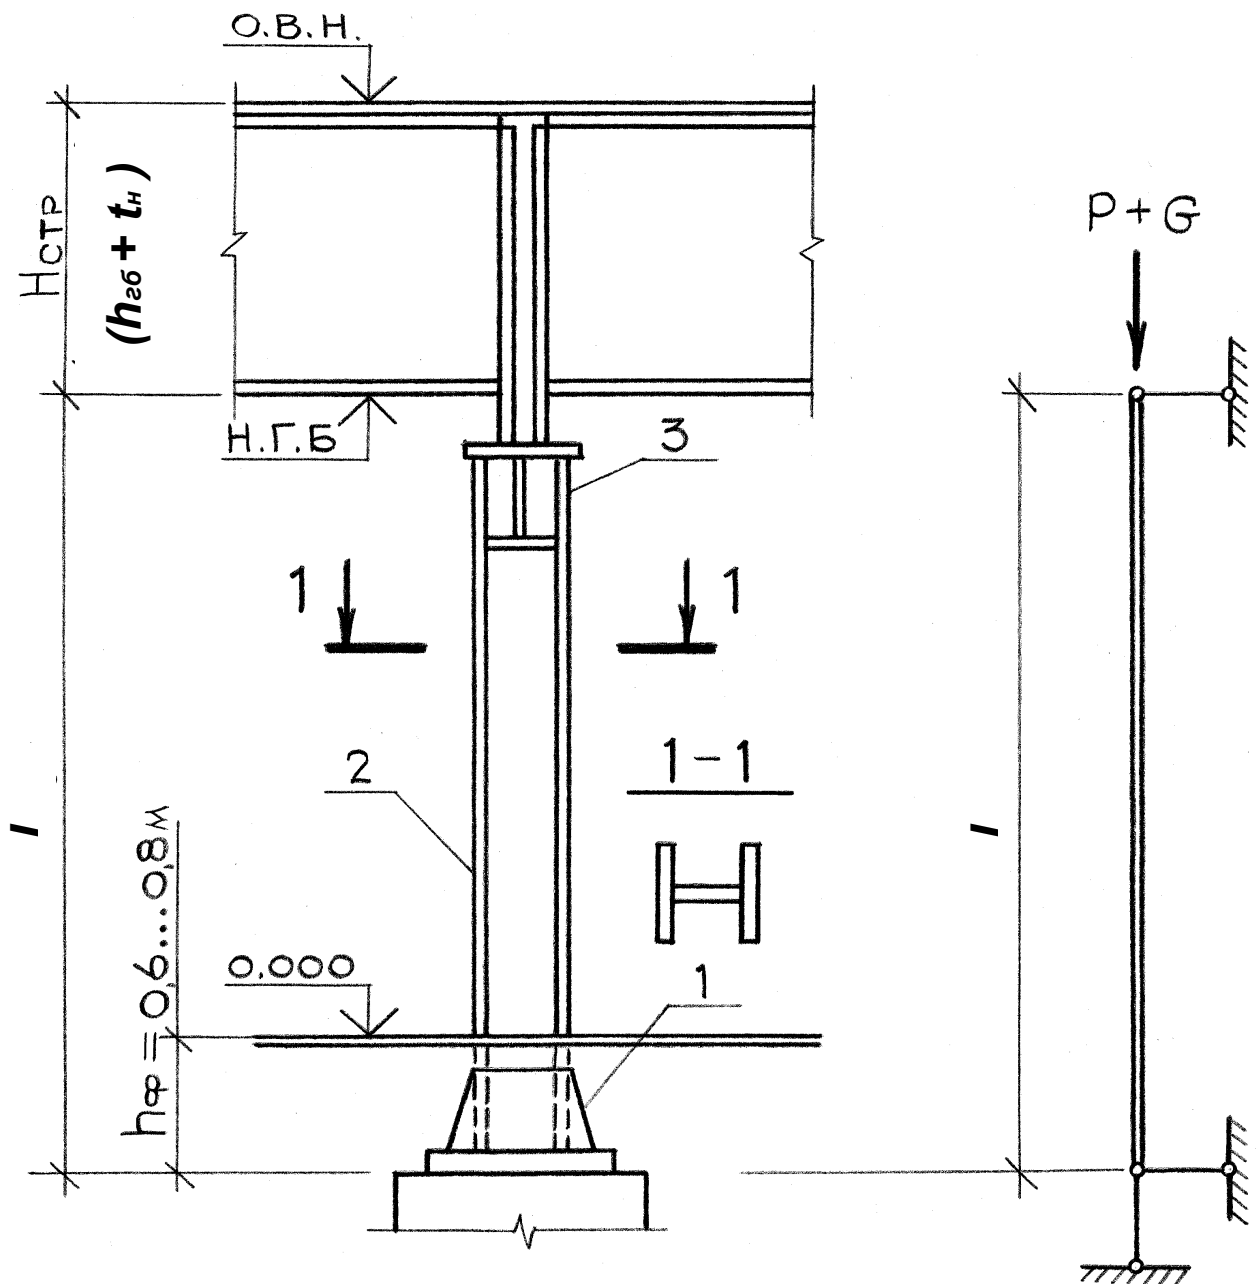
Конструкция и расчетная схема колонны 1 – база; 2 – стержень; 3 – оголовок.
